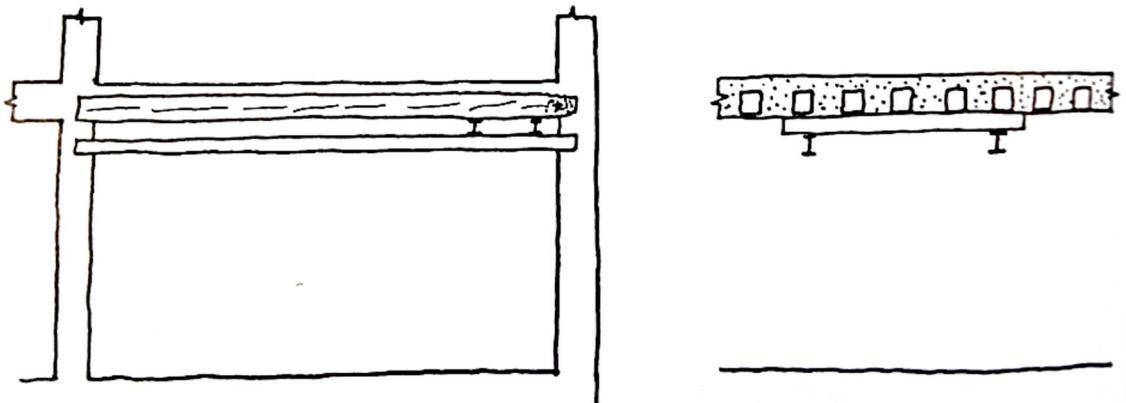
Apeo cabeza de viga con viga carrera apoyada sobre elementos metálicos.
